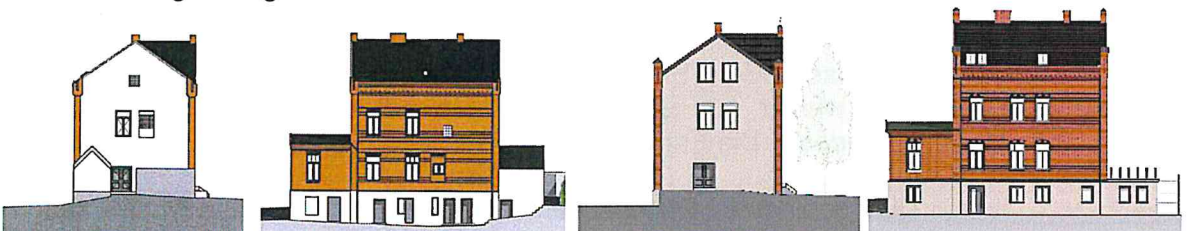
Süd- und Westfassade: Bestand (l.) und geplanter Umbau (r.)
